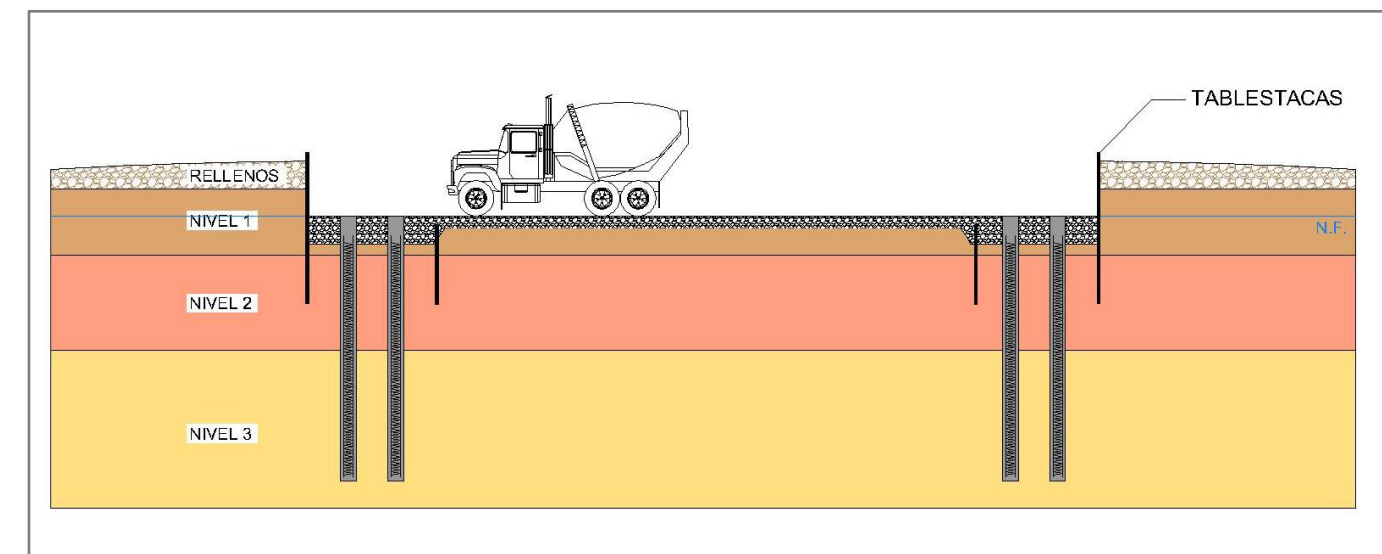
Excavación, entubación, colocación de armadura y hormigonado,
